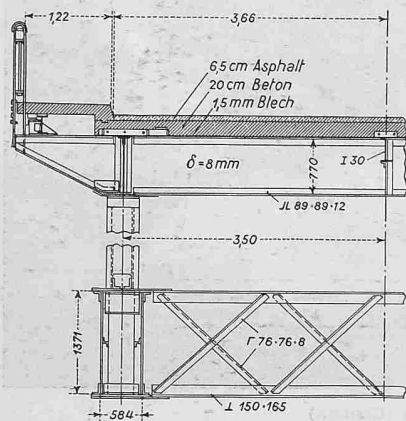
Querschnitt durch Fahrbahn und Bogenkonstruktion; 1:100
